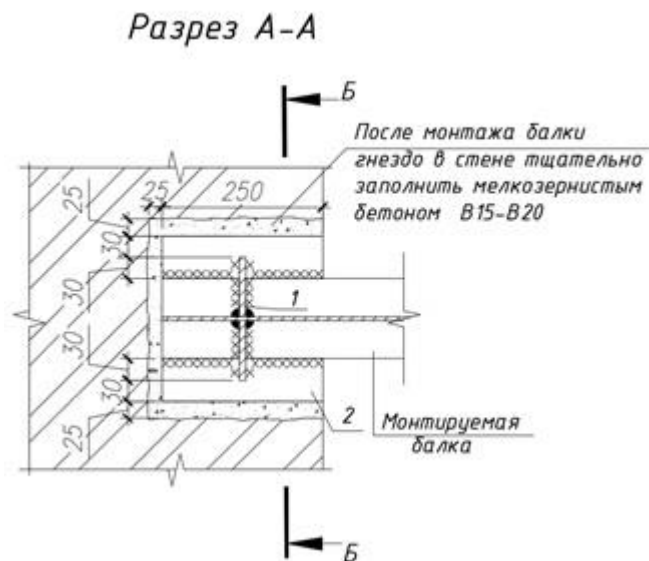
(Б). Узел опирания балки на кирпичную кладку. Разрез А-А
